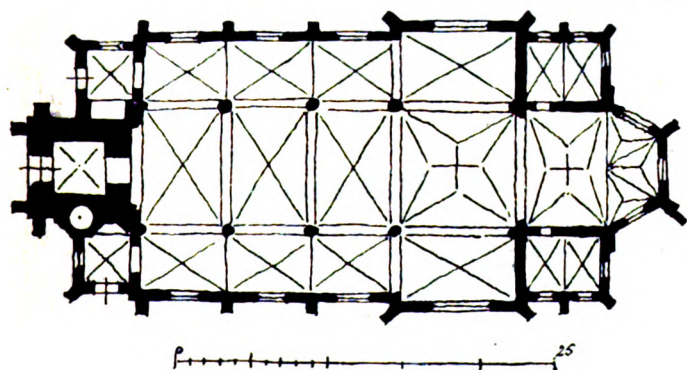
Grundriss zur Pfarrkirche in Hersel.
